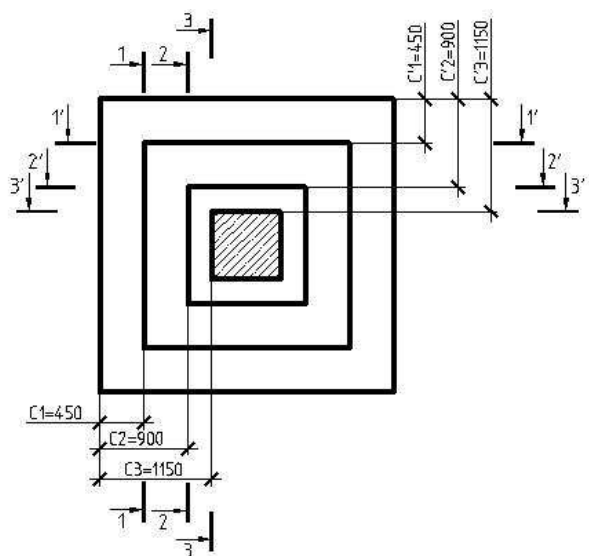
Схема к расчету арматуры плитной части фундамента
